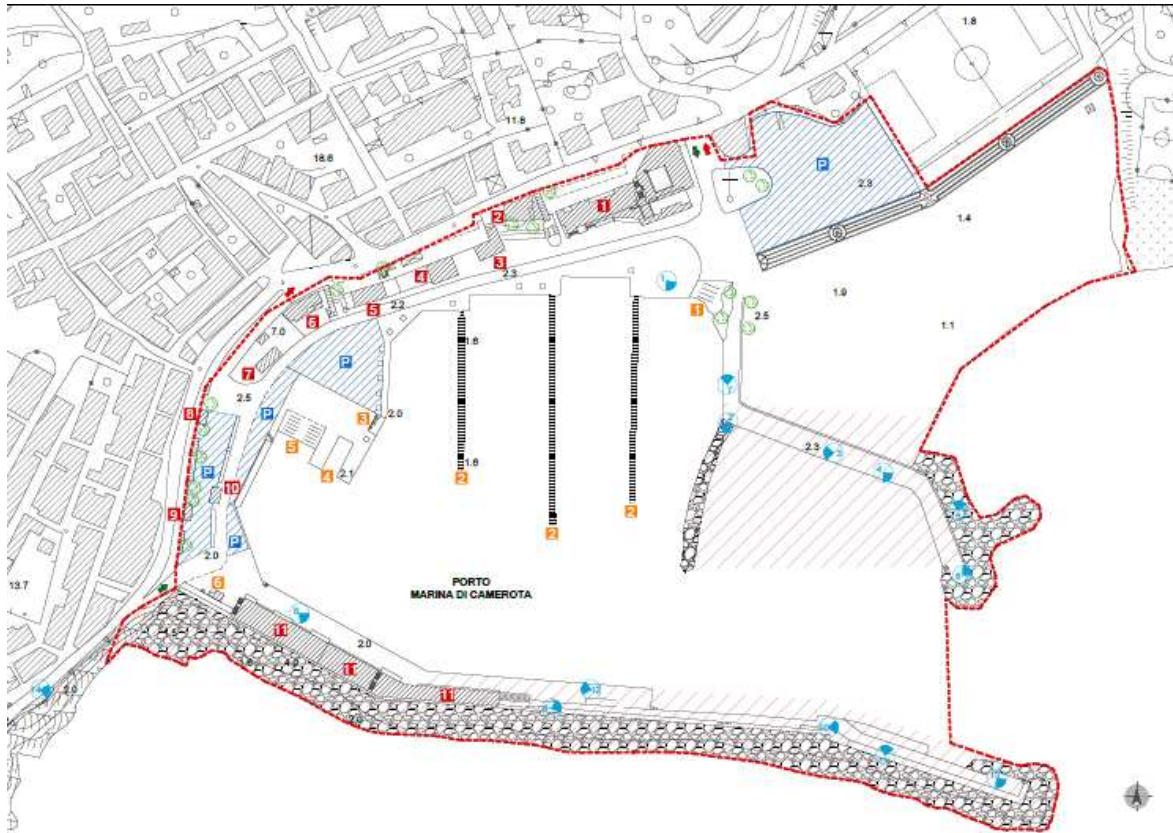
Planimetria ambito portuale – Stato di fatto
